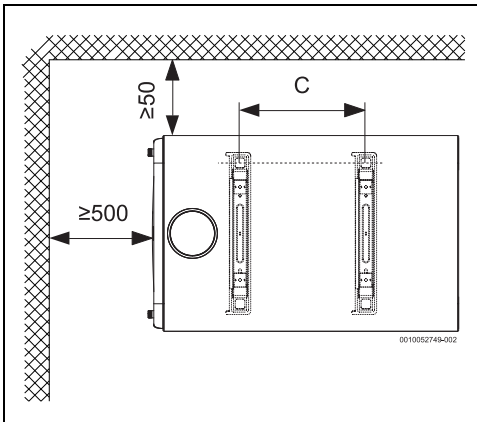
Dimensões em mm (montagem mural, instalação horizontal)
